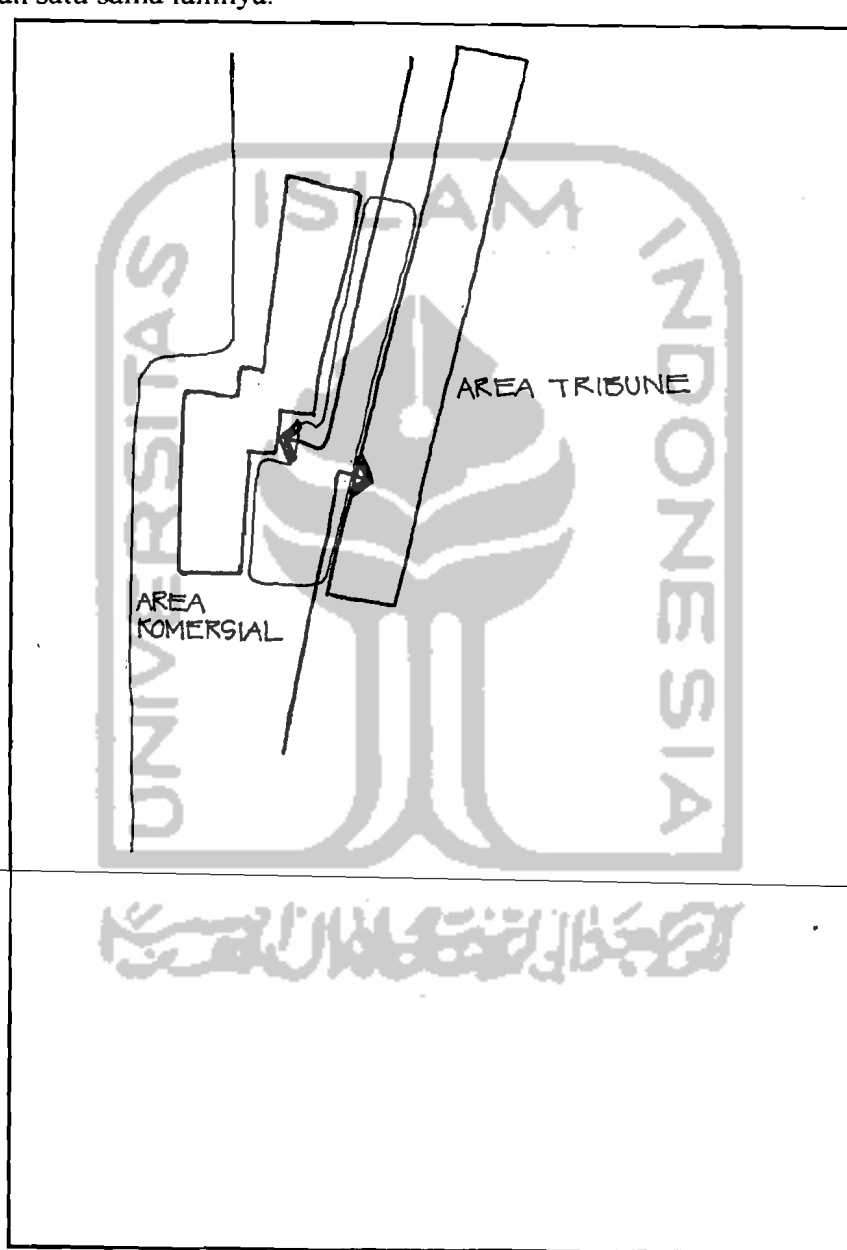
Pencapaian ke bangunan dengan sirkulasi langsung
